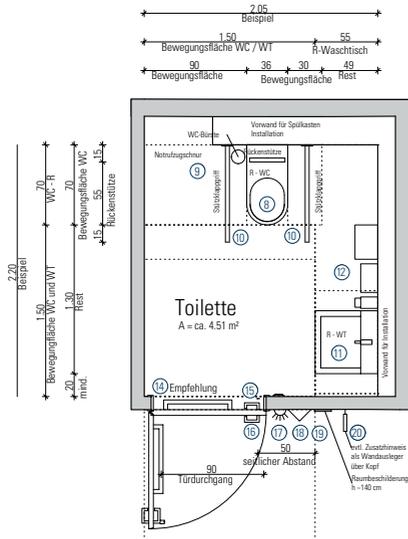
Standard-Grundriss barrierefreie Einraum-Toilette gemäß DIN 18040-1
